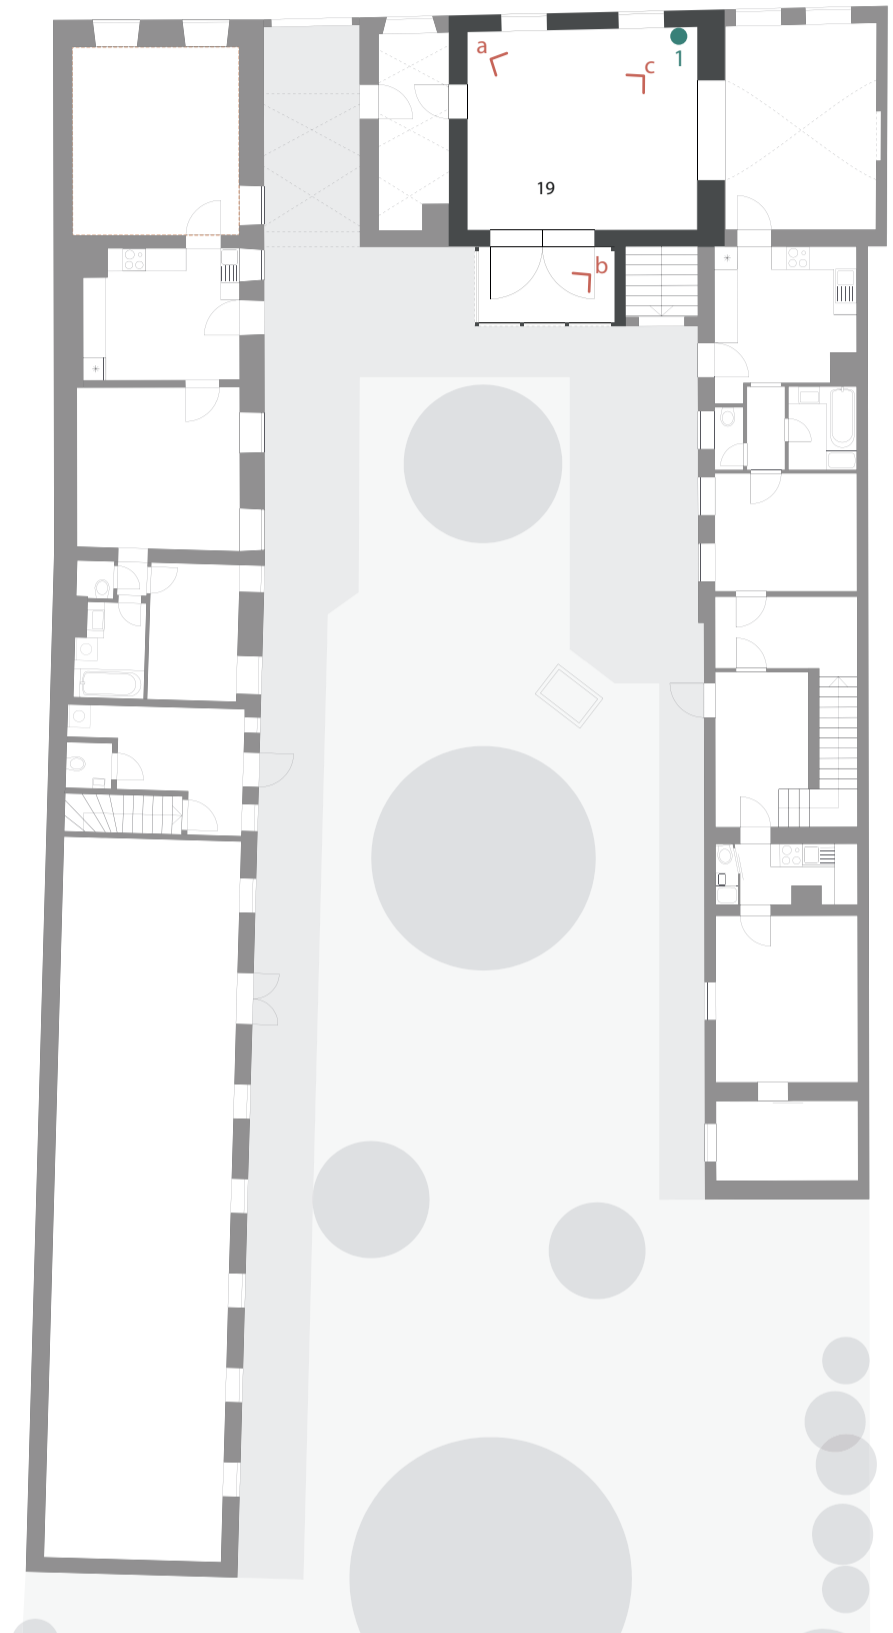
Grundriss Erdgeschoß | M 1:200 | Raum 19
